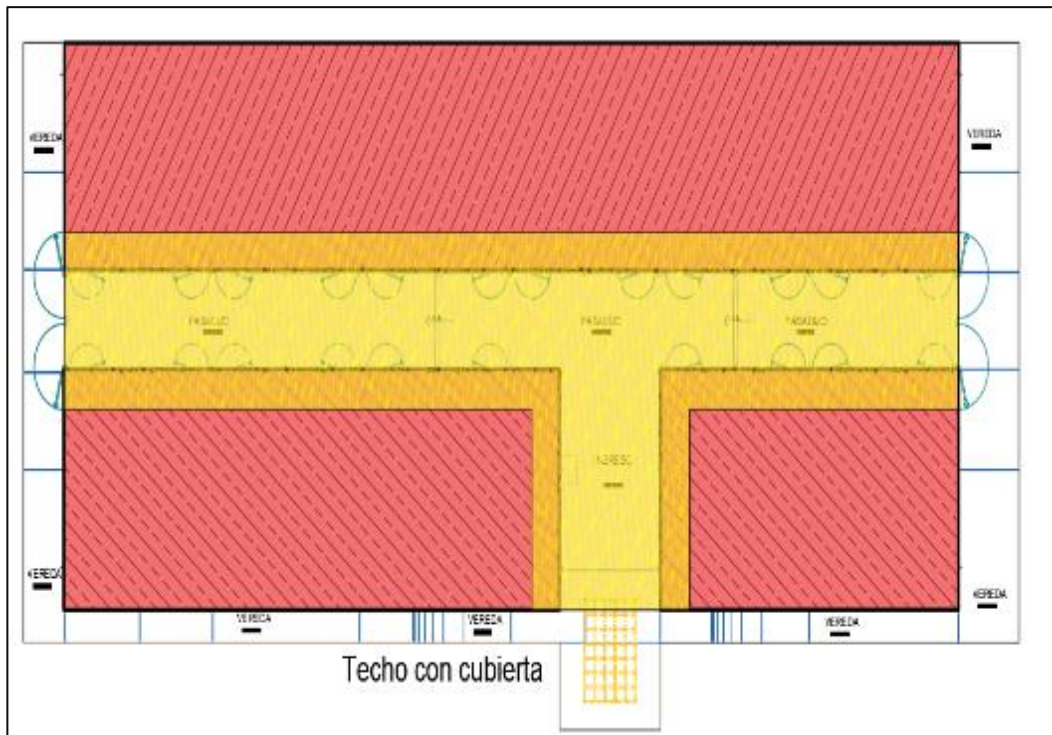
Vista en planta del techo del pabellón J- FIUPLA
